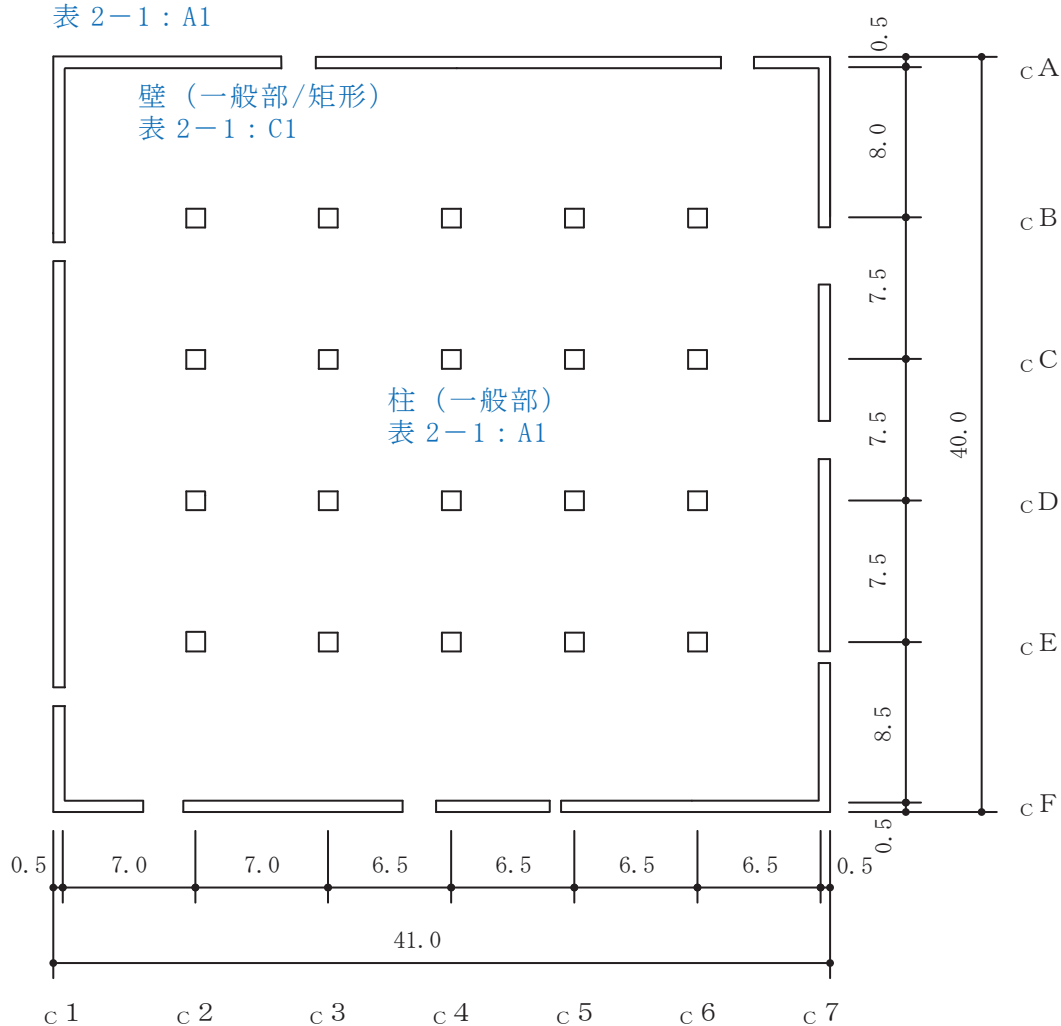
(2) 制御建屋の概略平面図 (0. P. 8. 0m)
